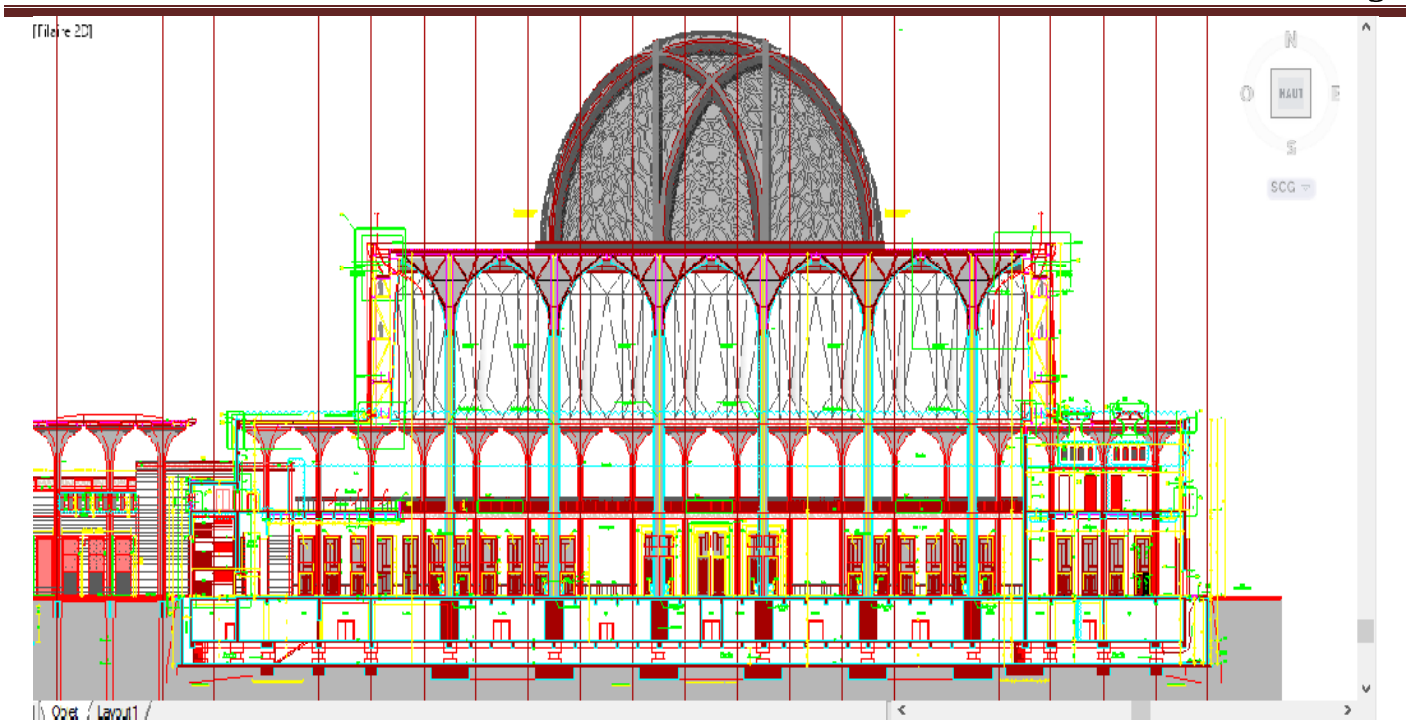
élévation nord de la salle de prière puise par AutoCAD.
